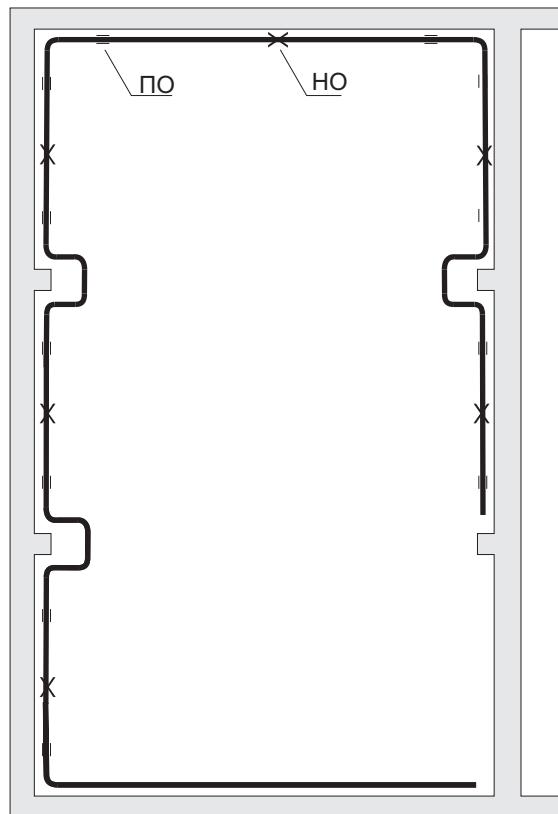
Размещение точек крепления вертикальной трубы в многоэтажном здании
